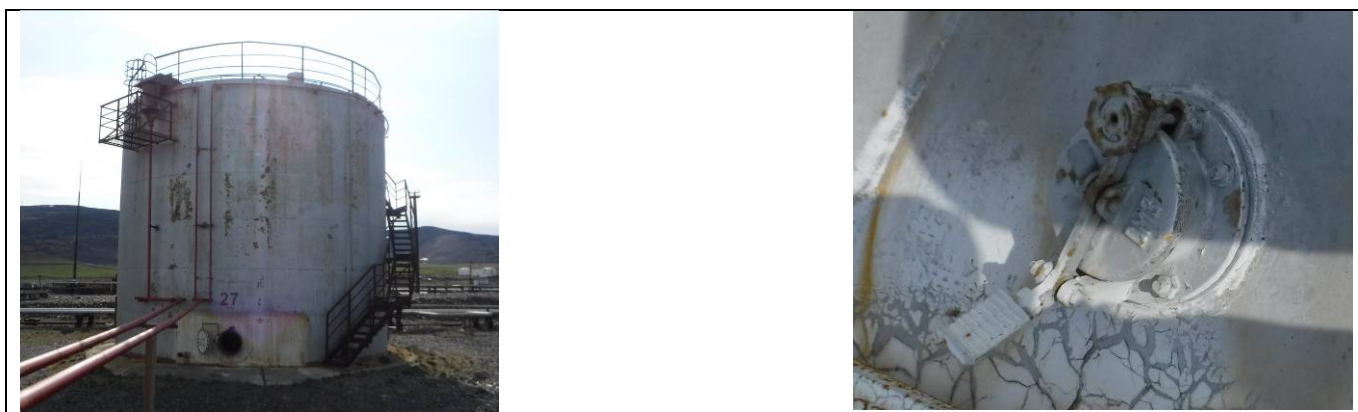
Общий вид резервуара РВС-700 (№27) с замерным люком
